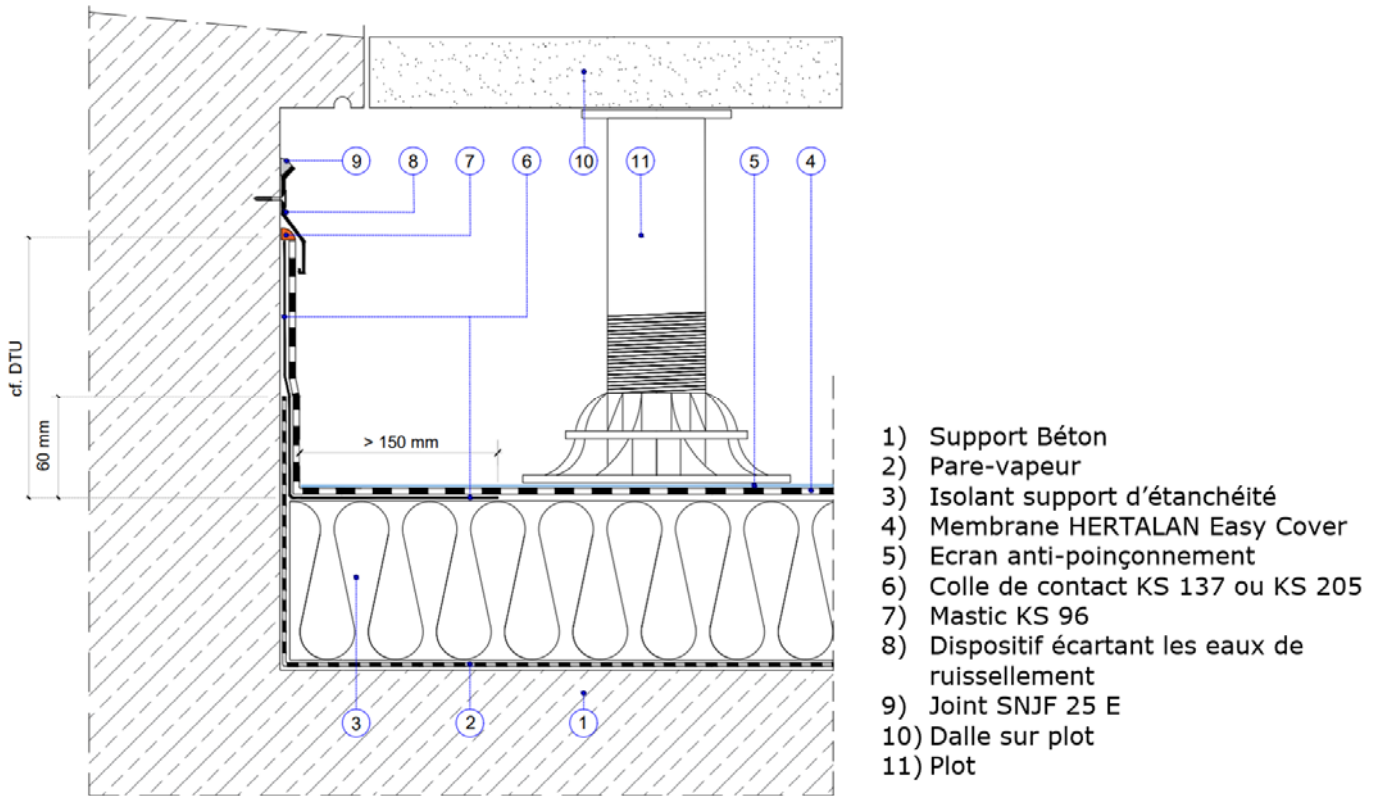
Exemple de relevé d'étanchéité – Terrasse accessible aux piétons et séjour sous protection dalles sur plots
